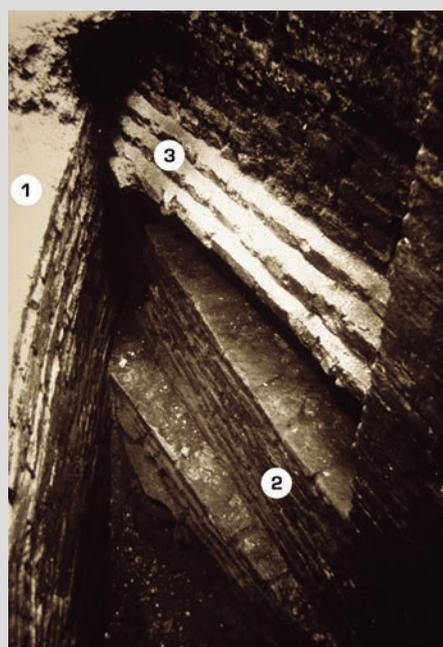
Santa Sofia: pilastro costruito sull'interfaccia di demolizione dell'absidiola nord della cripta.
